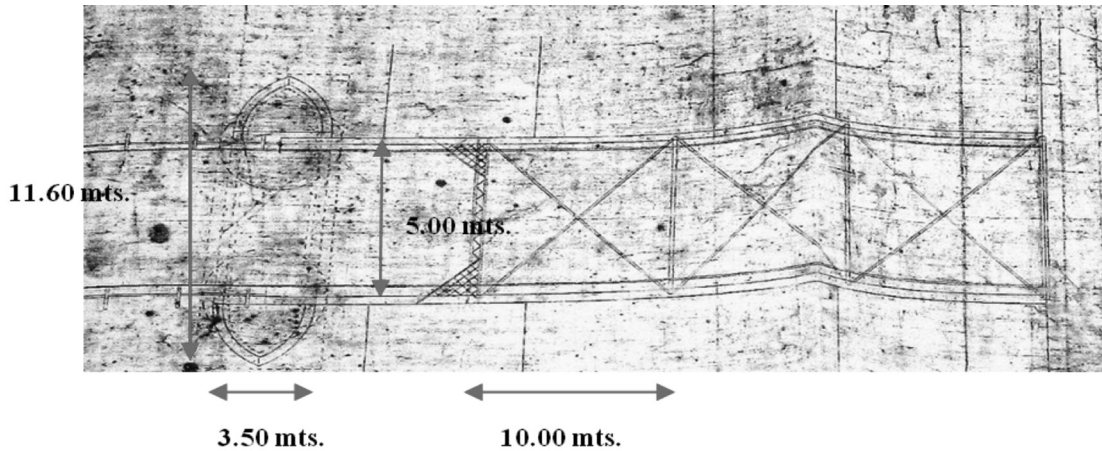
Plano de obra. Planta. Fuente: (planos) Dirección de Hidráulica Sección Dolores.
